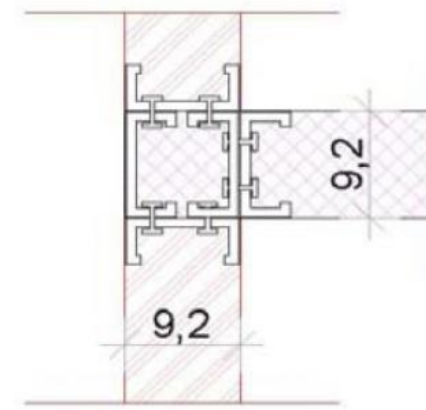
Ligação (DD). Fonte: Portal metálica, 2011.
